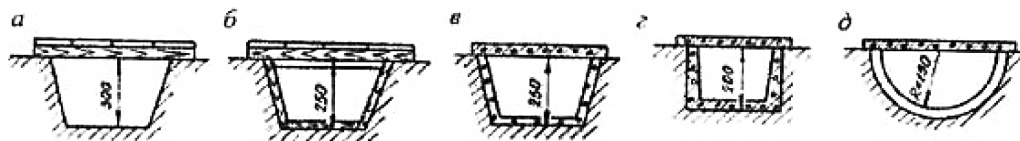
Конструкции водоотливных канавок: а) без крепи, б) с деревянной крепью, в) с бетонной крепью, г) со сборными железобетонными лотками, д) со сборными лотками из асбестоцемента
